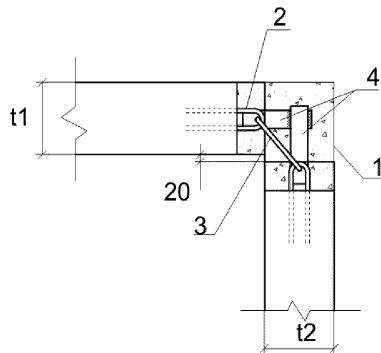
Соединение двух панелей углом: 1 – бетон замоноличивания; 2 – петлевые арматурные выпуски; 3 – соединительные скобы; 4 – соединительная пластина; b – 100–120 мм; t1, t2 – толщина стены (140–250 мм)
